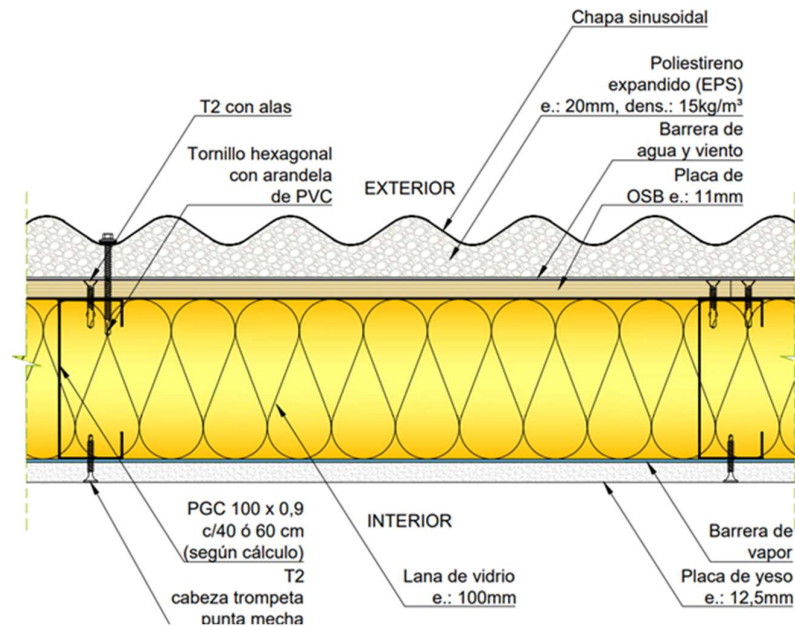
| Detalle muro exterior. Fuente: www.incose.org.ar
